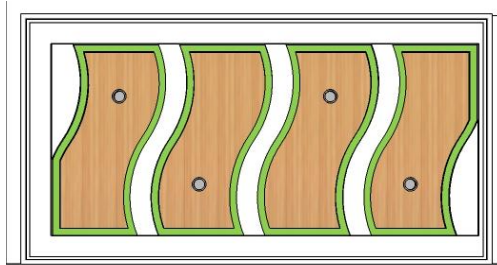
Alternatif 2 *ceiling* ruang rapat dan seminar
